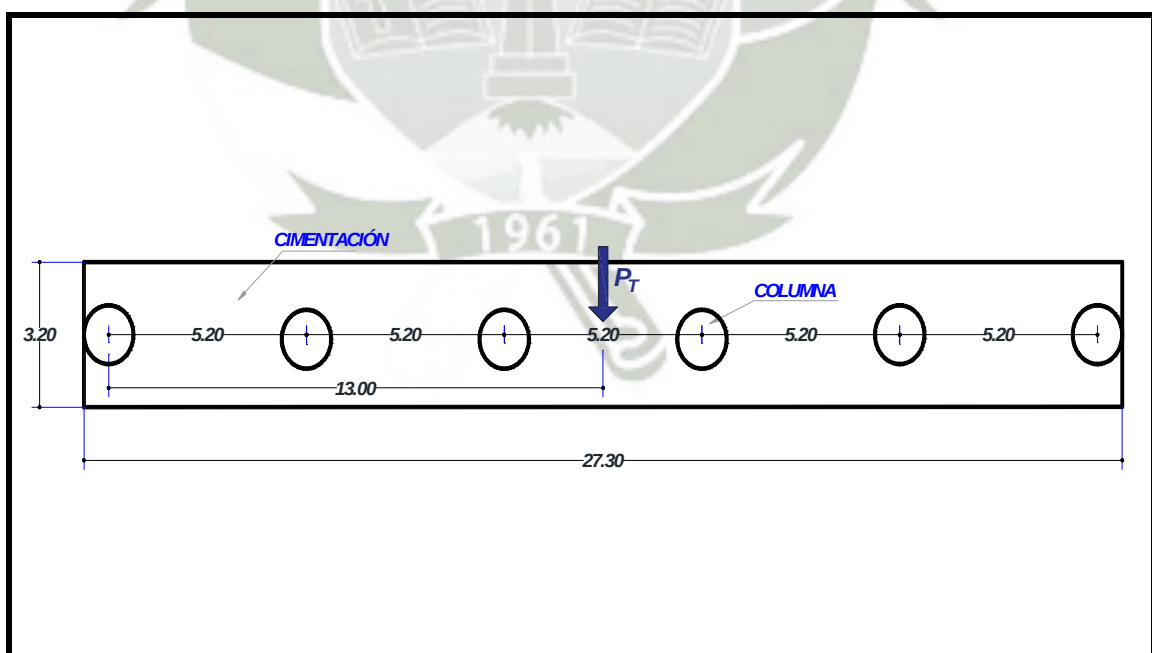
Pre-dimensionamiento de Cimentación para Pilares de Concreto Armado,
